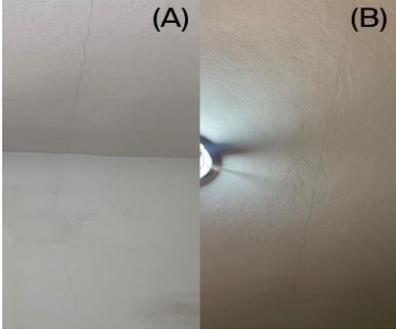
Fissura na cerâmica da parede da cozinha
